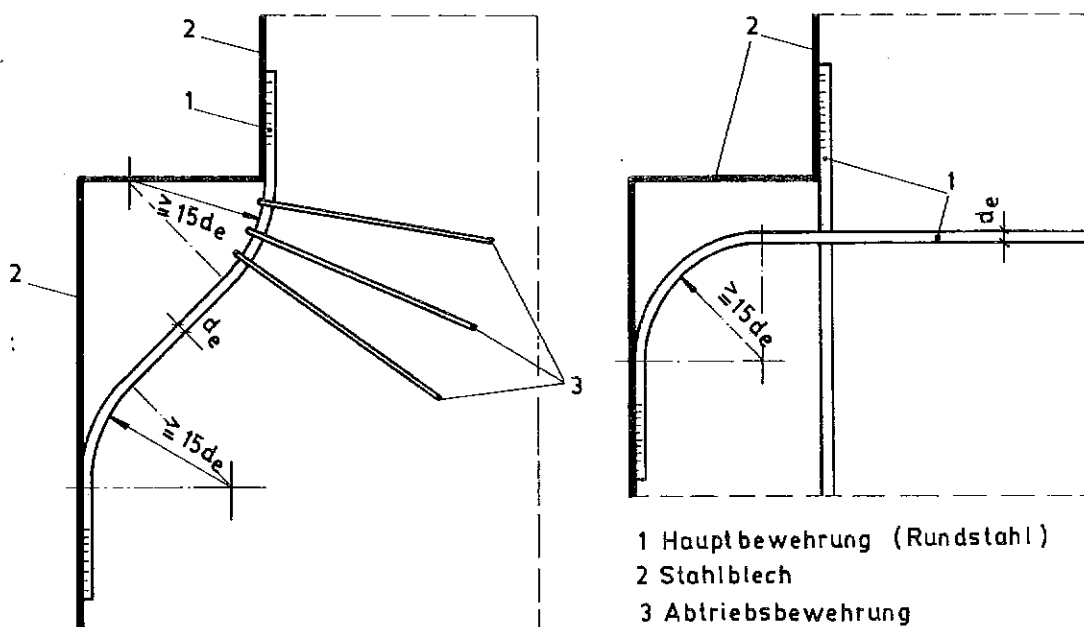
Rundstahlbewehrung bei Sprüngen in der Wanddicke
